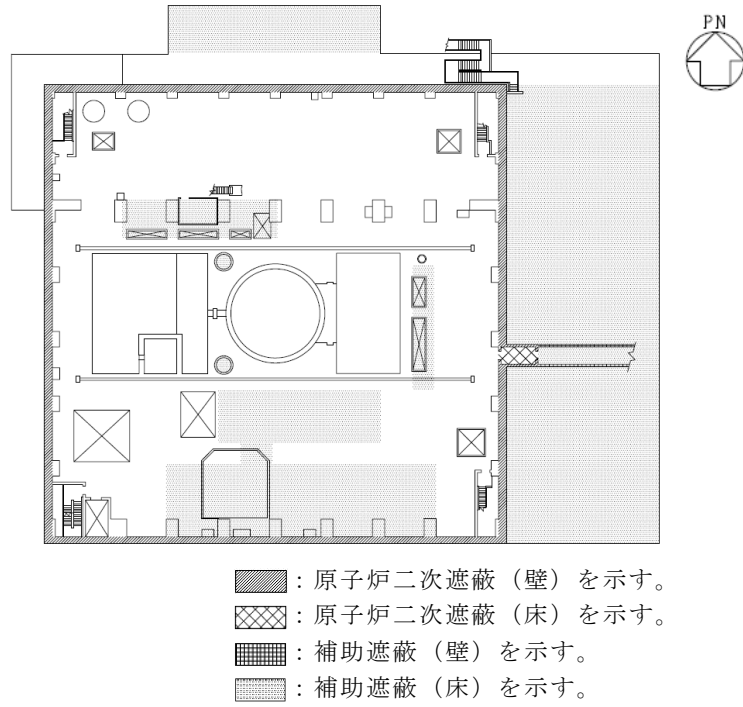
(9) 原子炉二次遮蔽及び補助遮蔽（原子炉建物）の範囲の平面図
